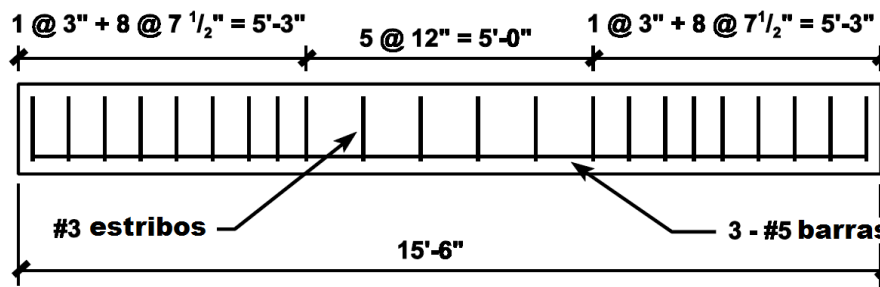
Distribuição da armadura longitudinal e transversal da viga de Foley & Buckhouse (1998).
